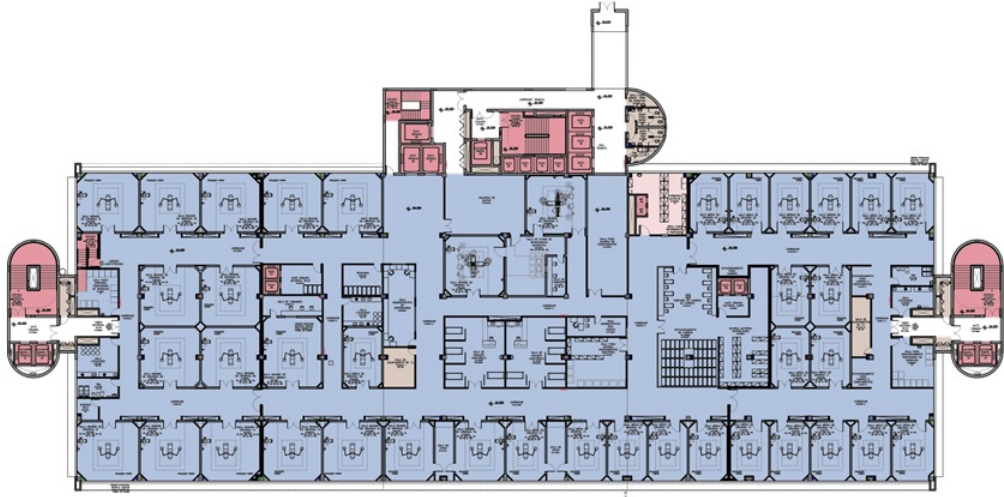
Anexo I - planta baixa do 4º pavimento. (Fonte: material de divulgação projeto de ampliação HCPA)
